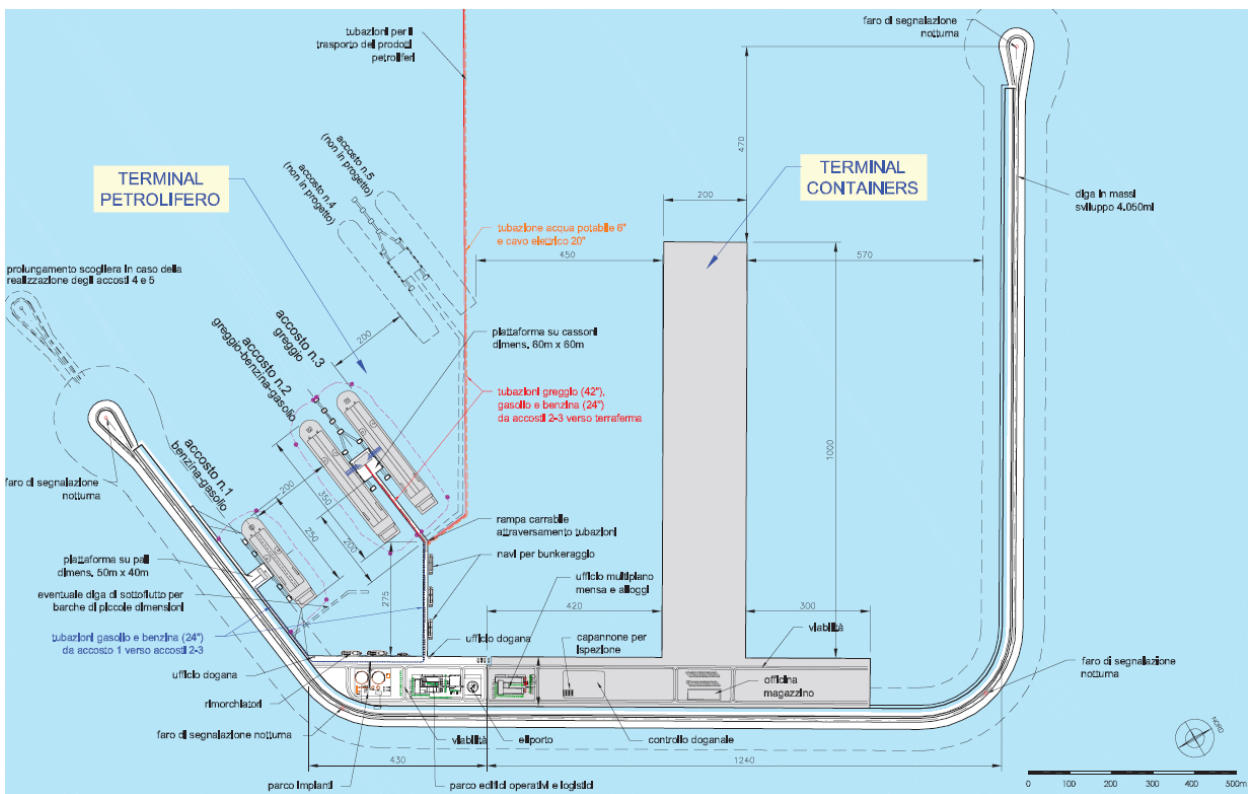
Planimetria Generale Terminal Plurimodale Offshore
